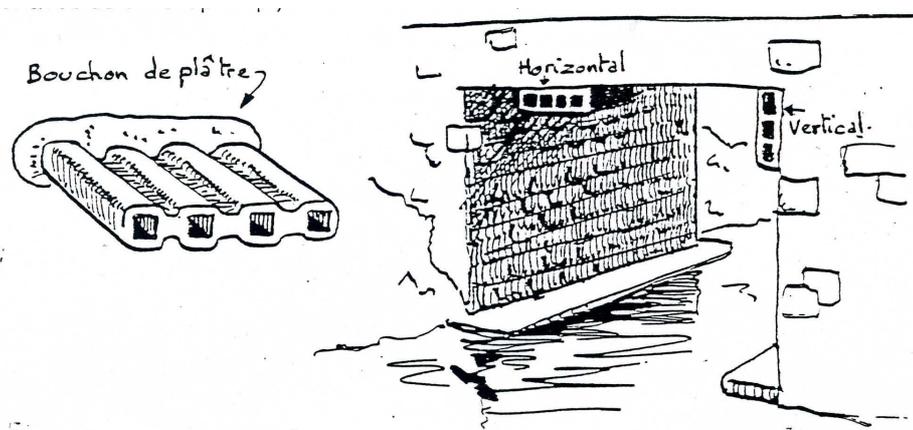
exemple d'abris installés sous un pont (source : FRAPNA).
